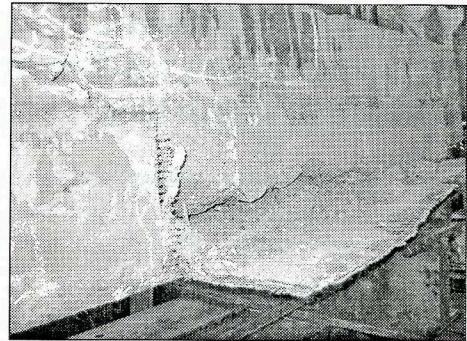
Плита № 2 с усилением двумя слоями углеродной сетки, пролет 4,2 м. Разрушение в трети пролета с разрывом накладки
